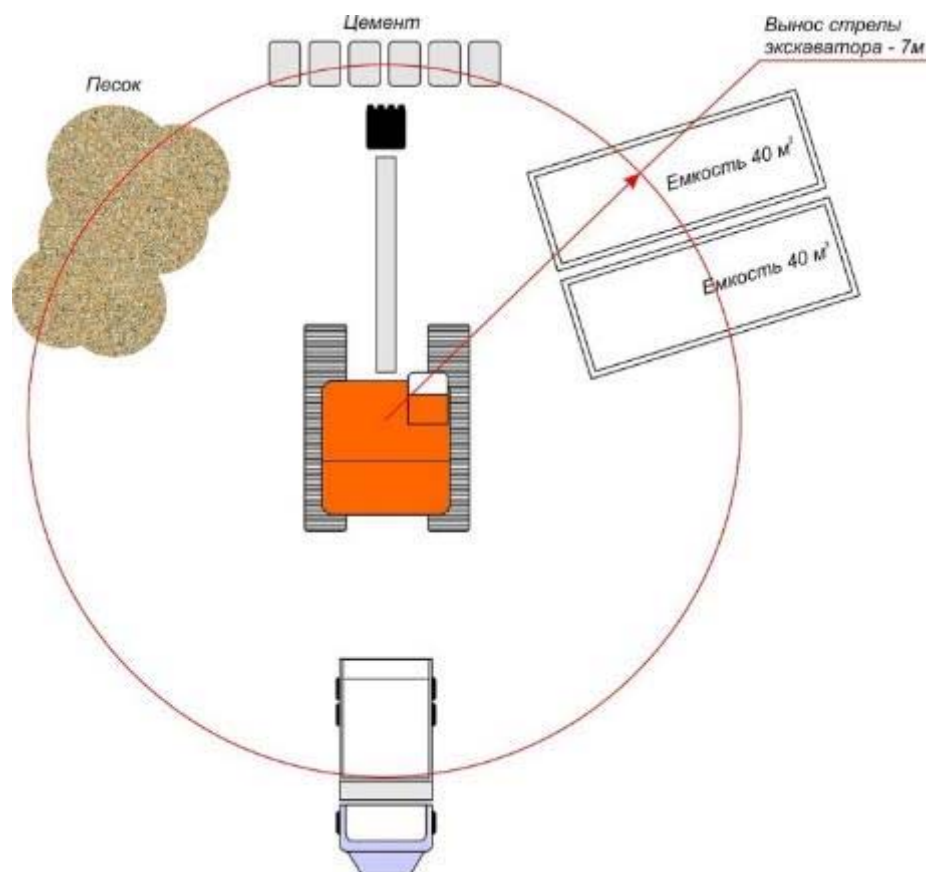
Схема площадки переработки бурового шлама в емкостях
